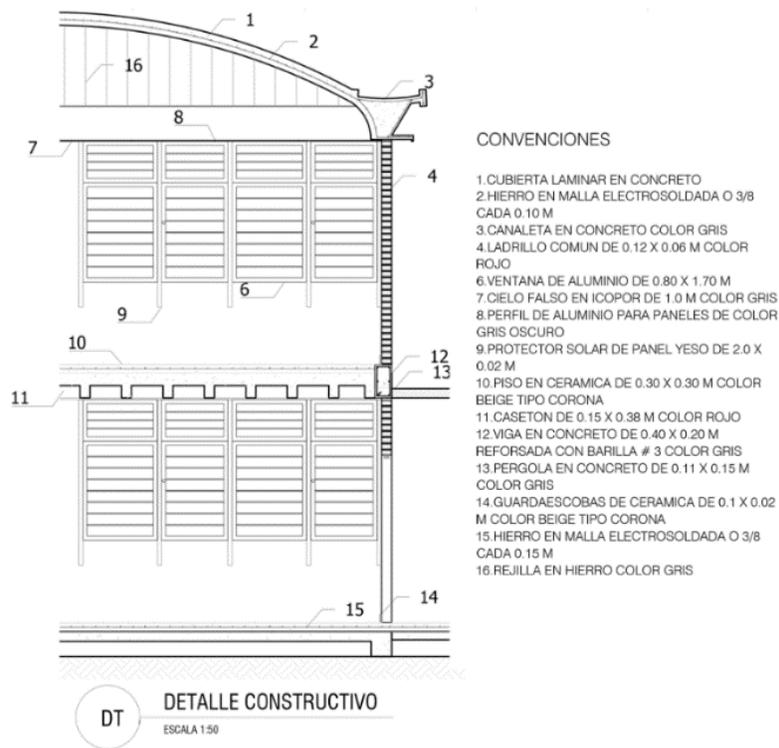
Detalle constructivo Estructura Edificio CEAI.
